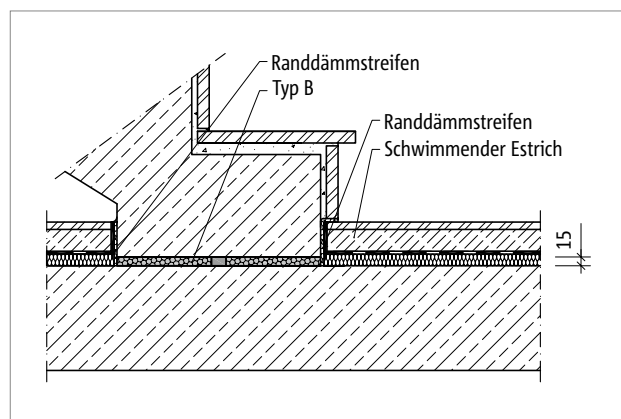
Schöck Tronsole® Typ B: Brandschutzausführung
